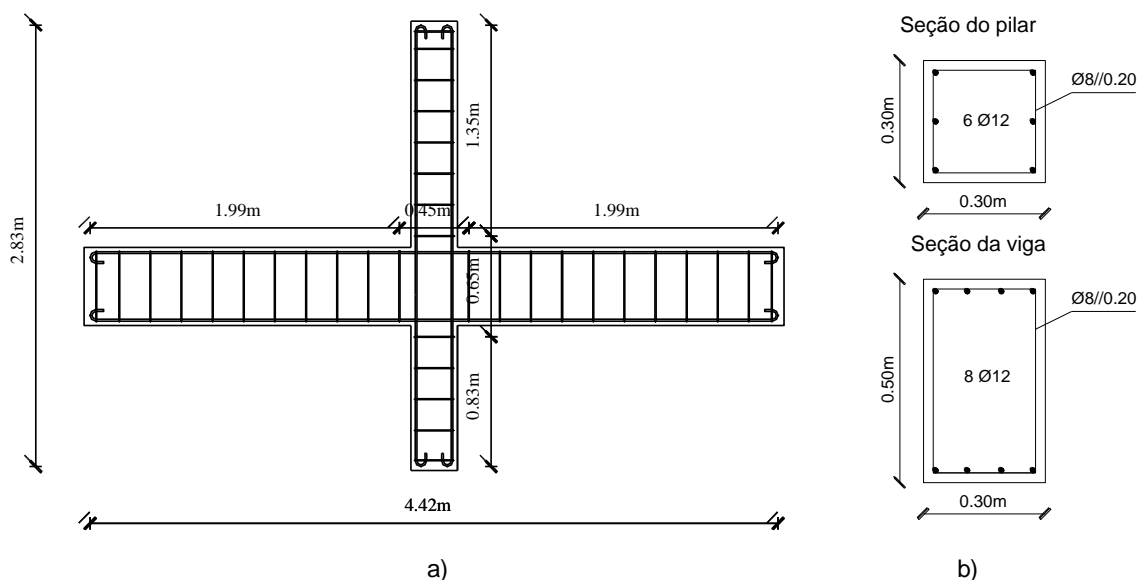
Armadura do provete ID; a) em planta; b) em corte.
